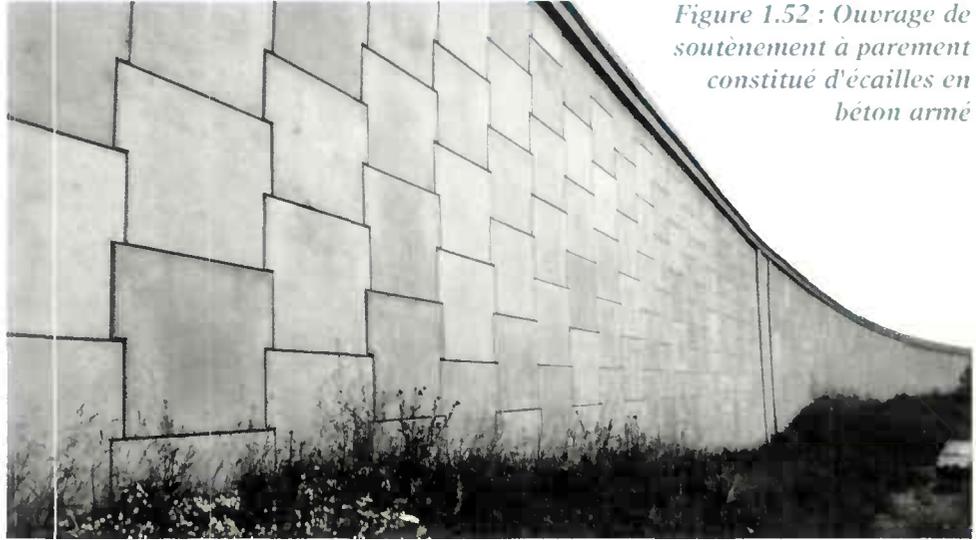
Ouvrage de soutènement à parement constitué d'écailles en béton armé
